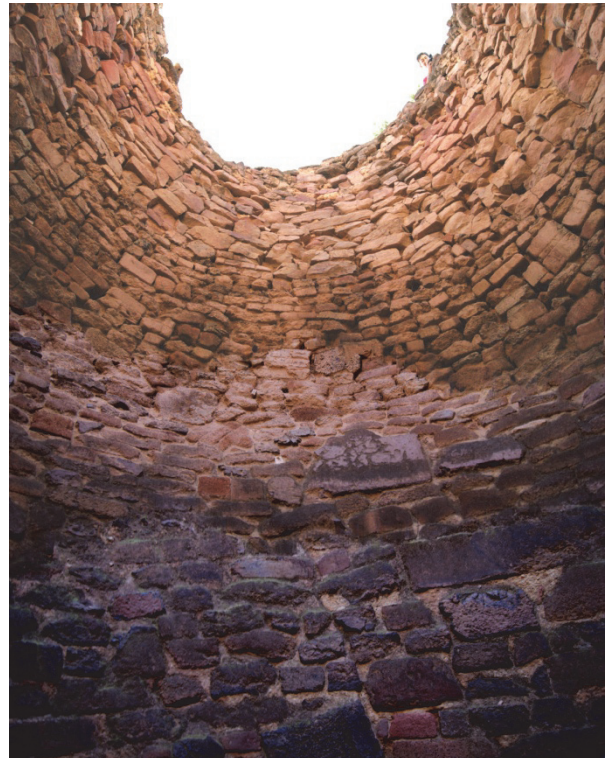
El muro interior donde se aprecian las piedras de rodeno.
